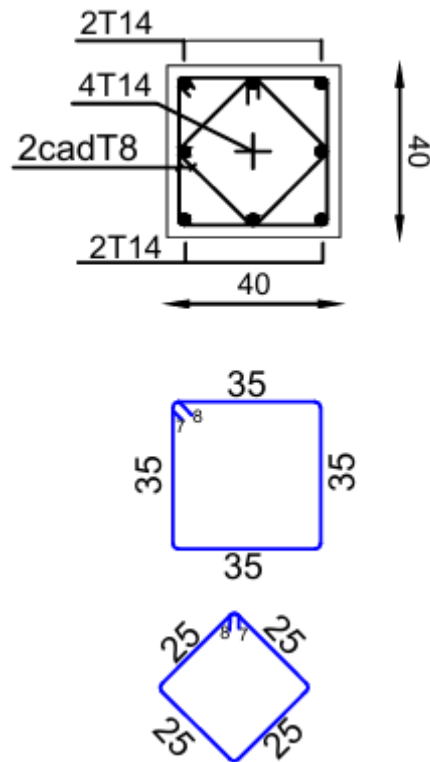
Schéma de ferrailage poteau de raidisseur de voile (40*40).
